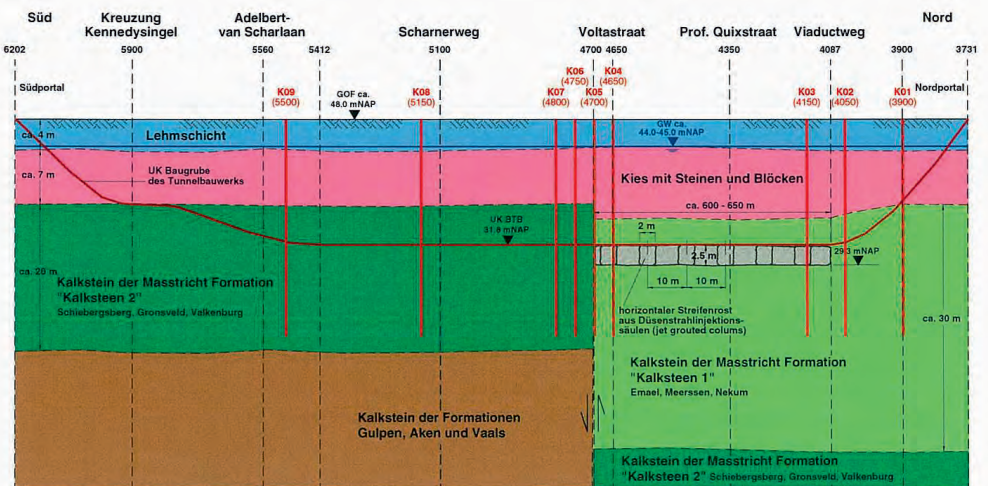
Längsschnitt des Tunnelbauwerk (Prinzipkizze, nicht maßstabgetreu)
